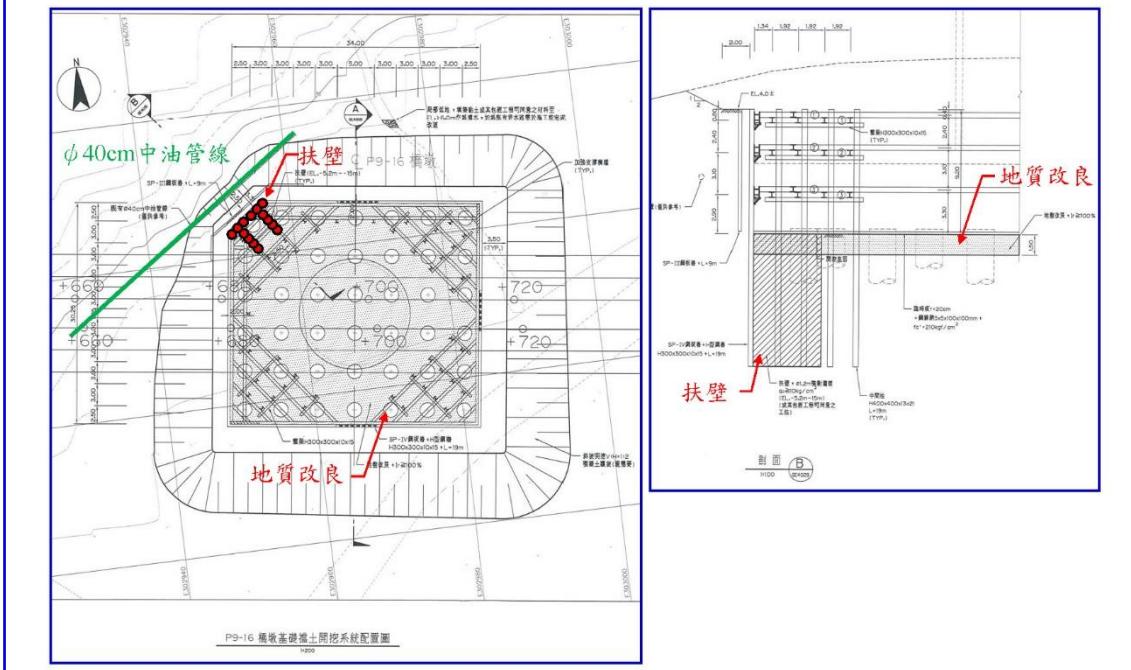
P9-16 擋土支撐平面及斷面示意圖
